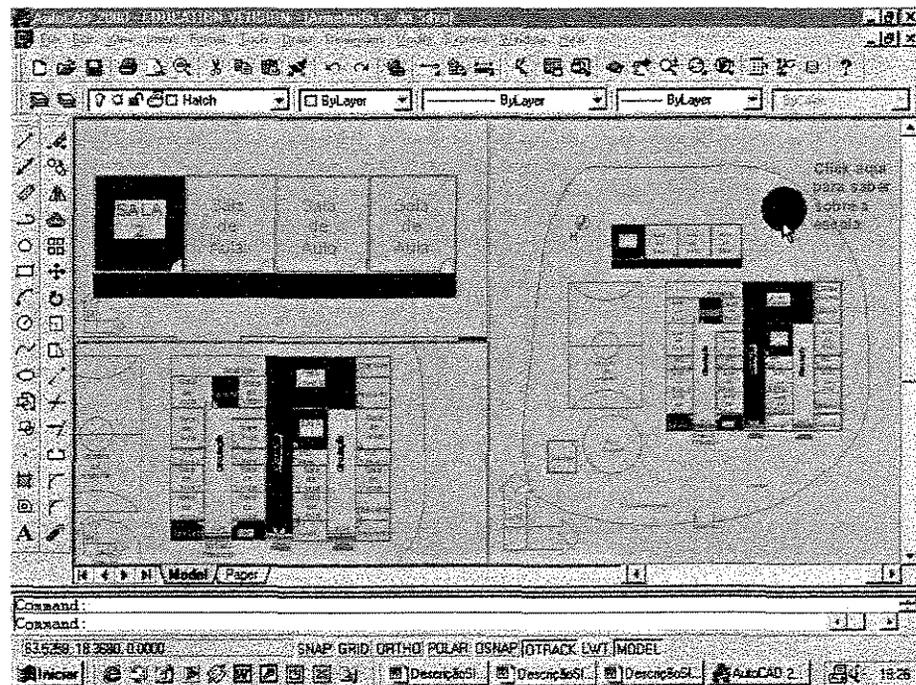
Tela do AutoCAD – Planta da escola Armelinda Espúrio da Silva
